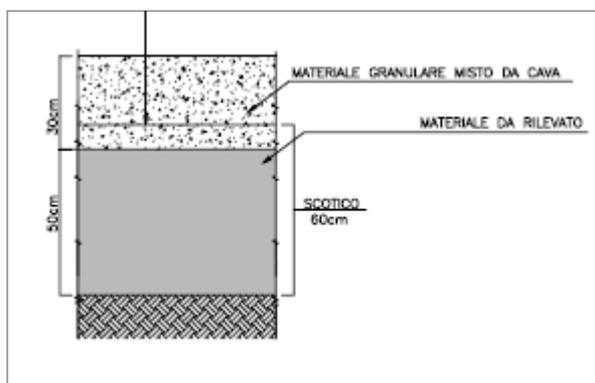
Particolare pavimentazione nelle aree di supporto
